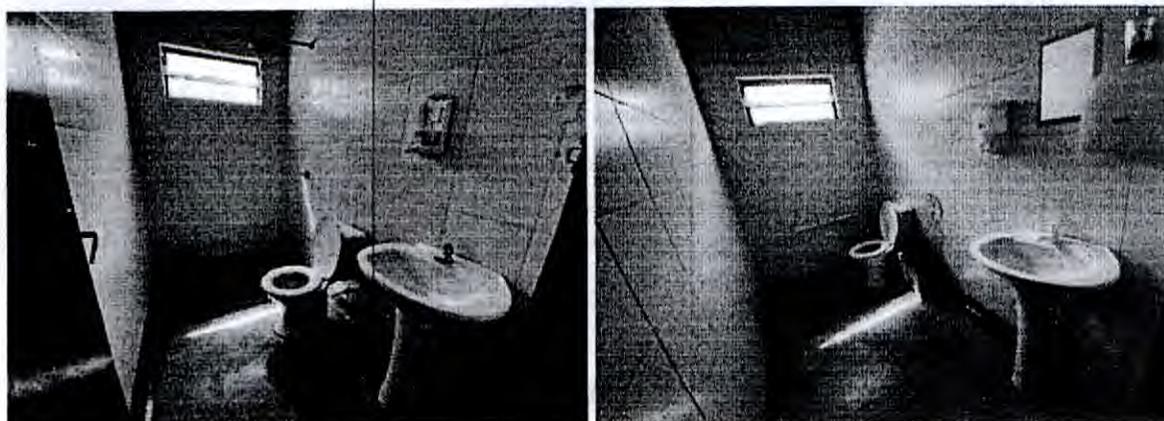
Banheiro com ausência de barras de apoio PcD;
